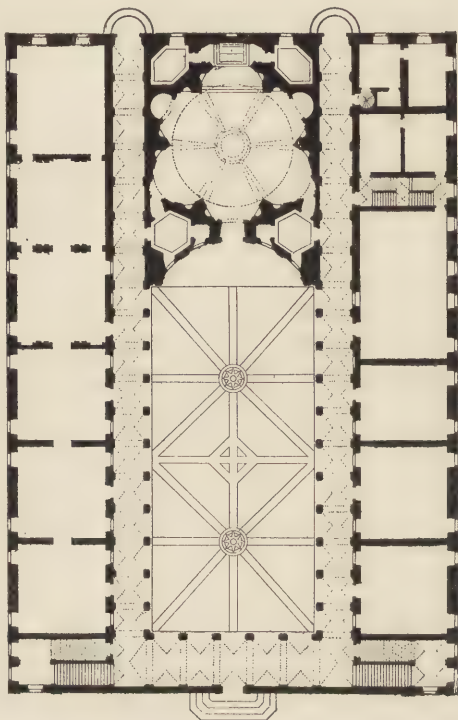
Sapienza und S. Ivo zu Rom, Grundriss.
